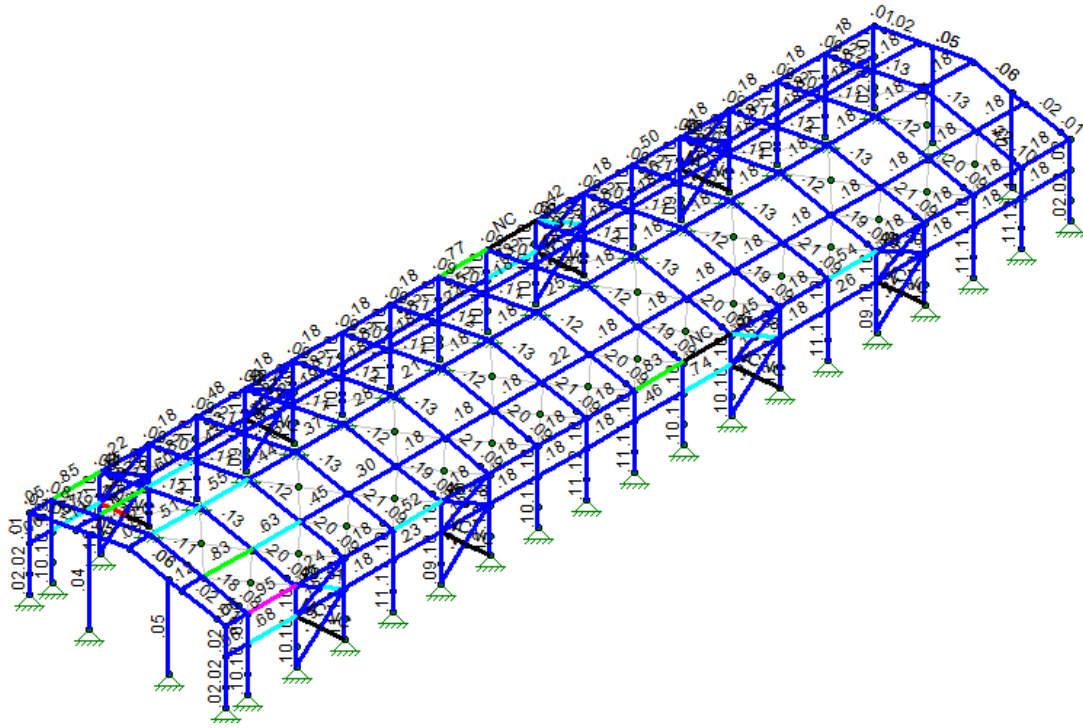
Factores de utilización con planta solar incorporada para DL+0.75ELZ+0.75ELY.
